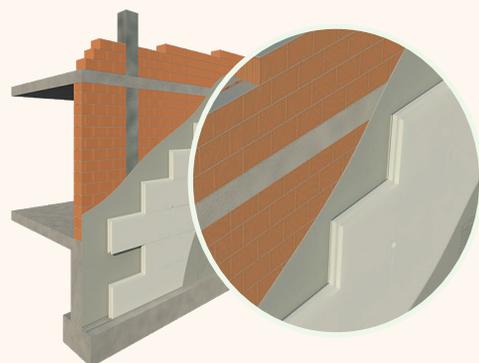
Fachada de bloque cerámico con sistema de aislamiento por el exterior (SATE)
